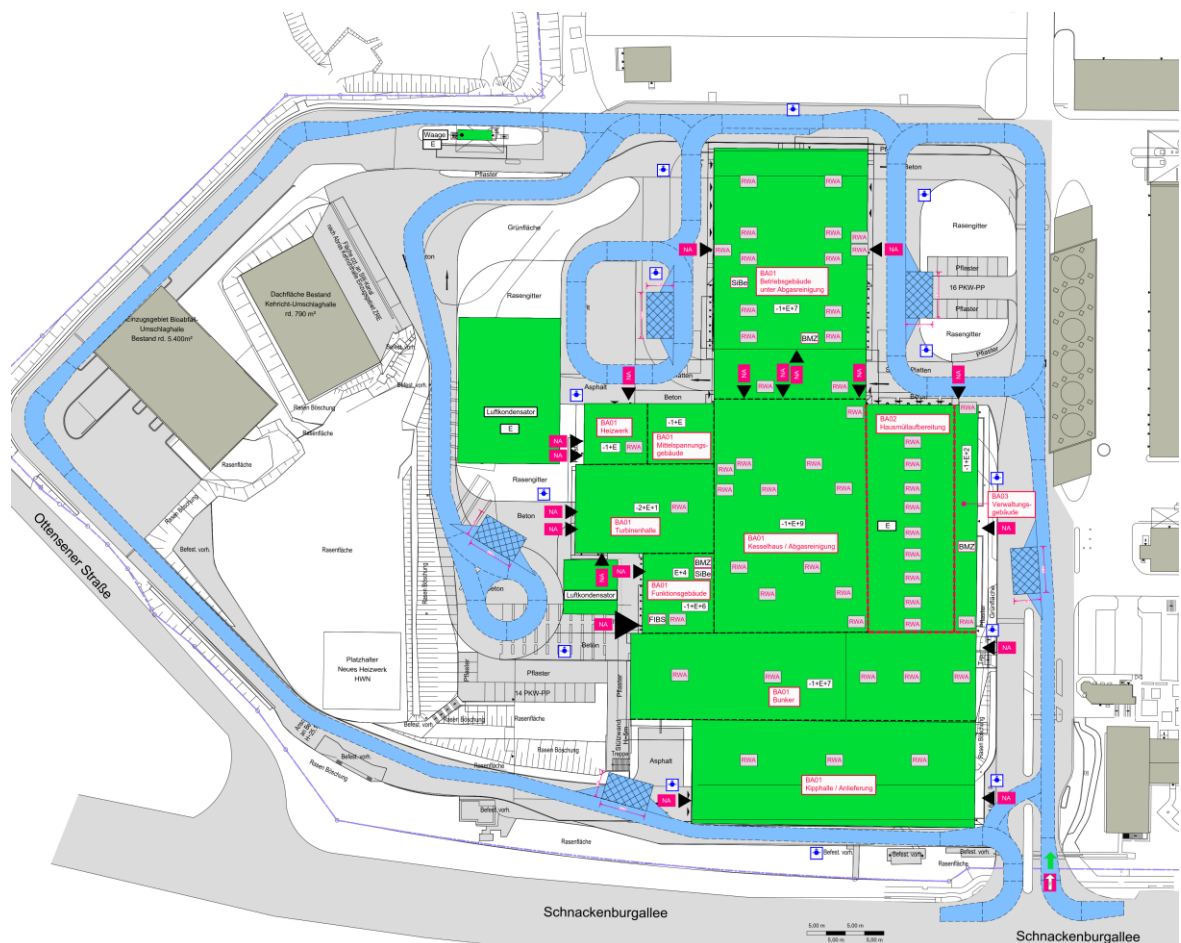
Lageplan des ZRE mit Darstellung der Feuerwehrumfahrt
